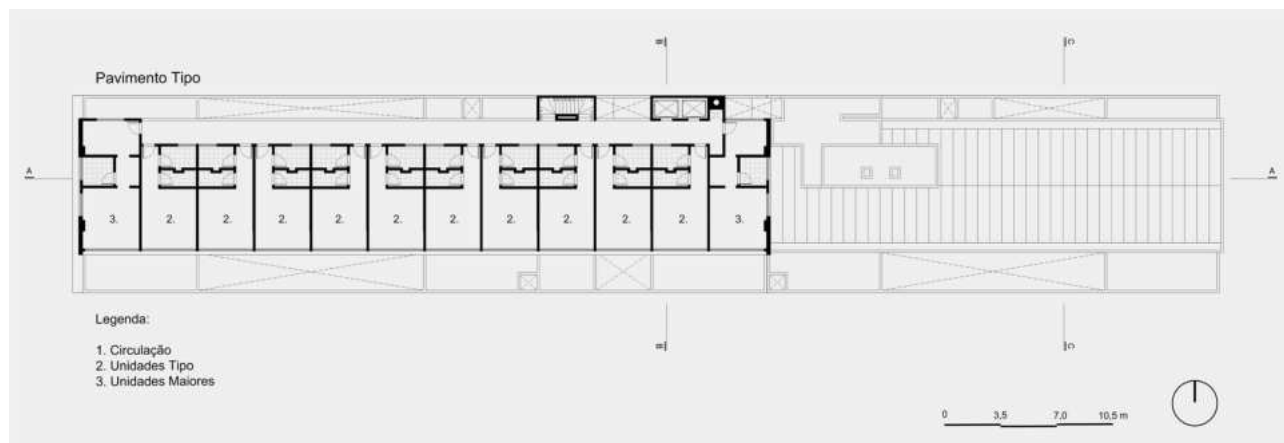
Planta baixa do pavimento tipo. Fonte: Autor, 2024.
